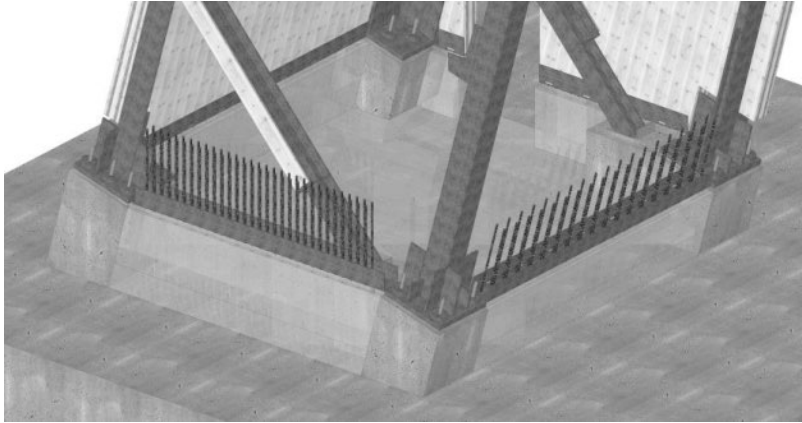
Anschluss Turm am Fußpunkt, Quelle: Werkstattplanung ZÜBLIN Timber
